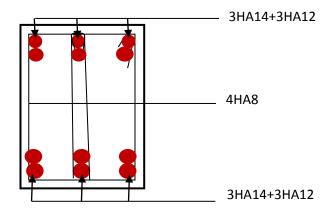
Ferraillage sur appuis d'une poutre principale.
